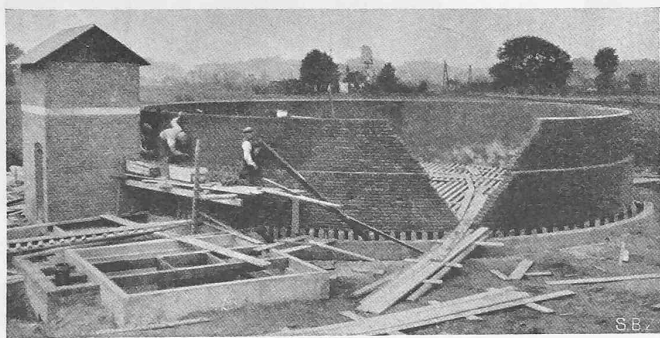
Bau eines Tropfkörpers (Drainageboden sichtbar).
